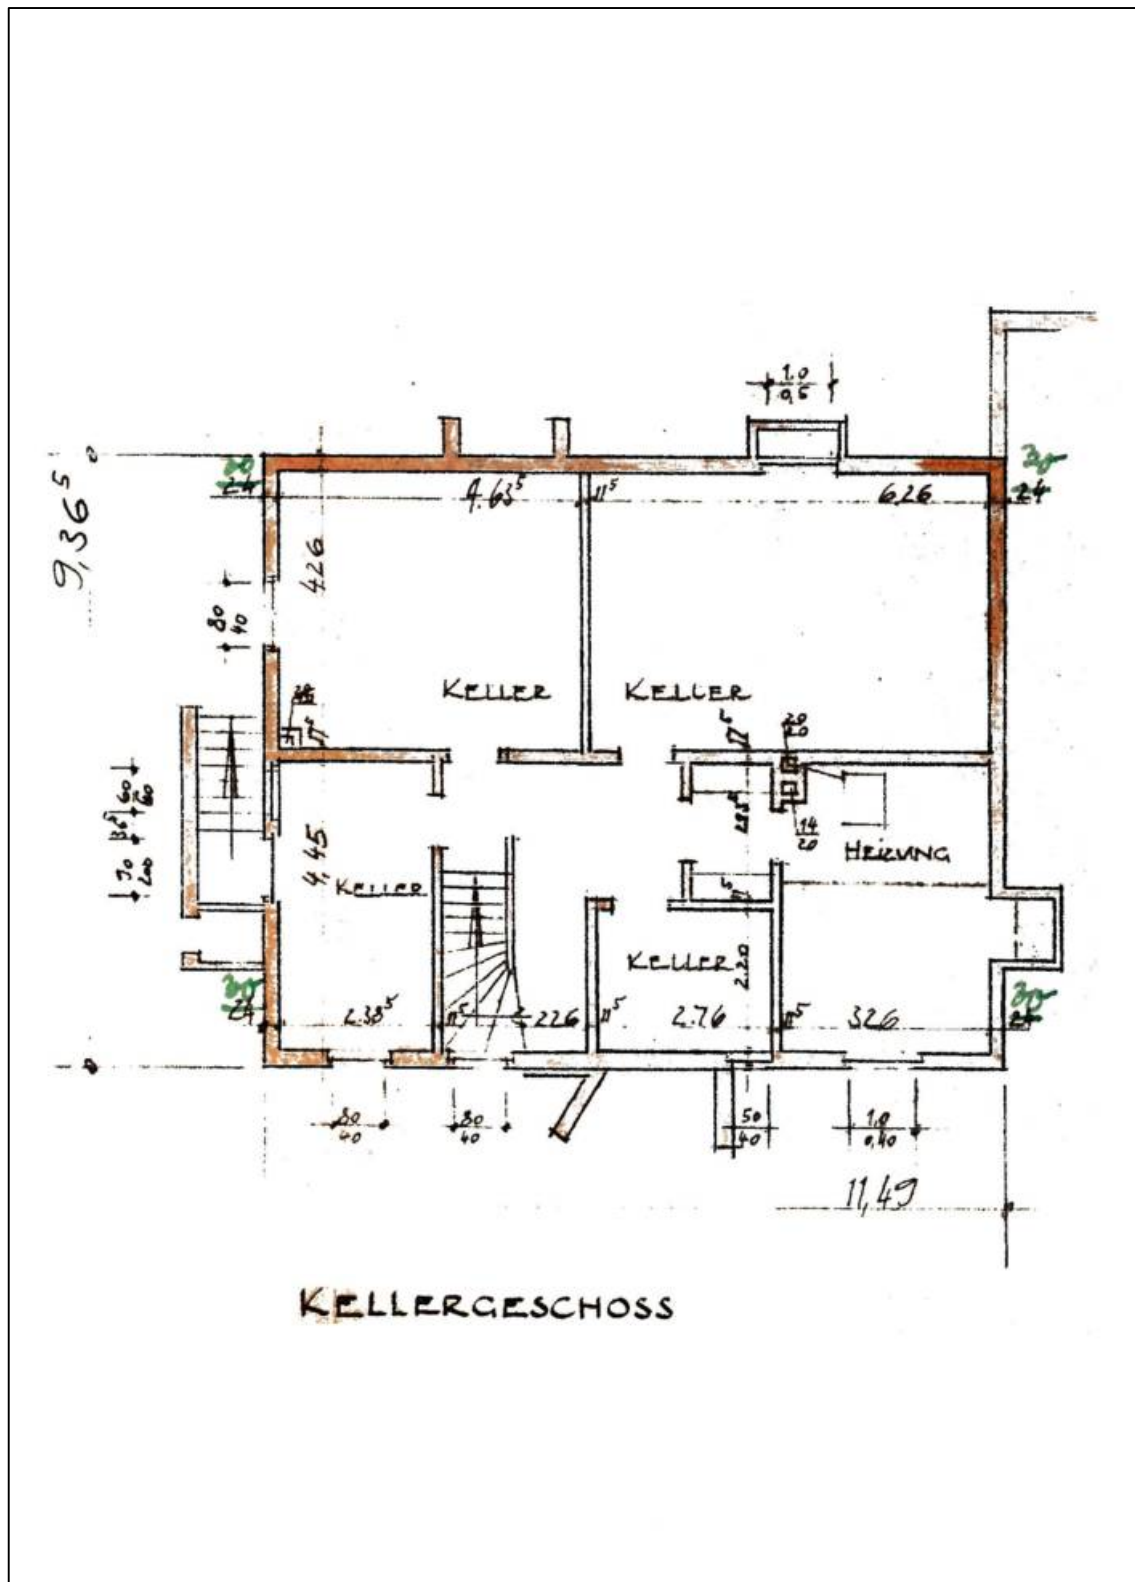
Grundriss vom Kellergeschoss
